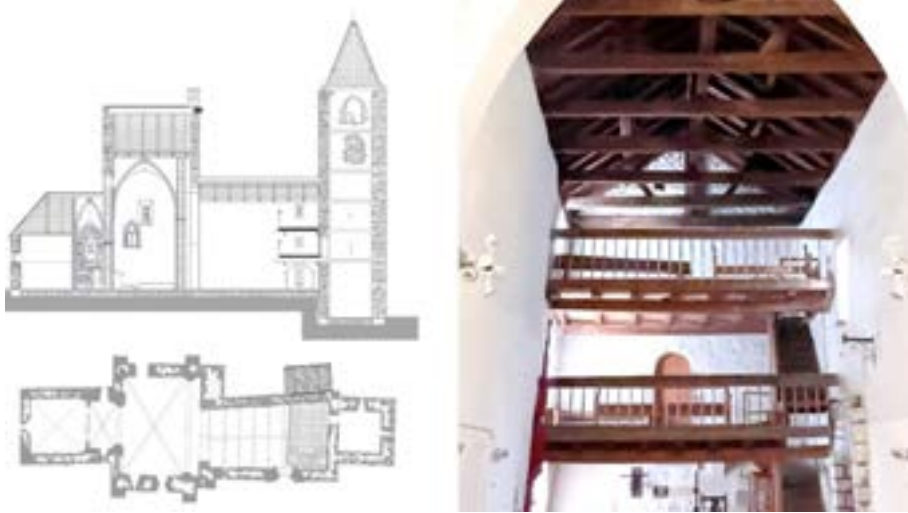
Planta e detalh dera seccion deth còr de dues plantes tipe balcon de Sant Pèir d'Escunhau [31]
